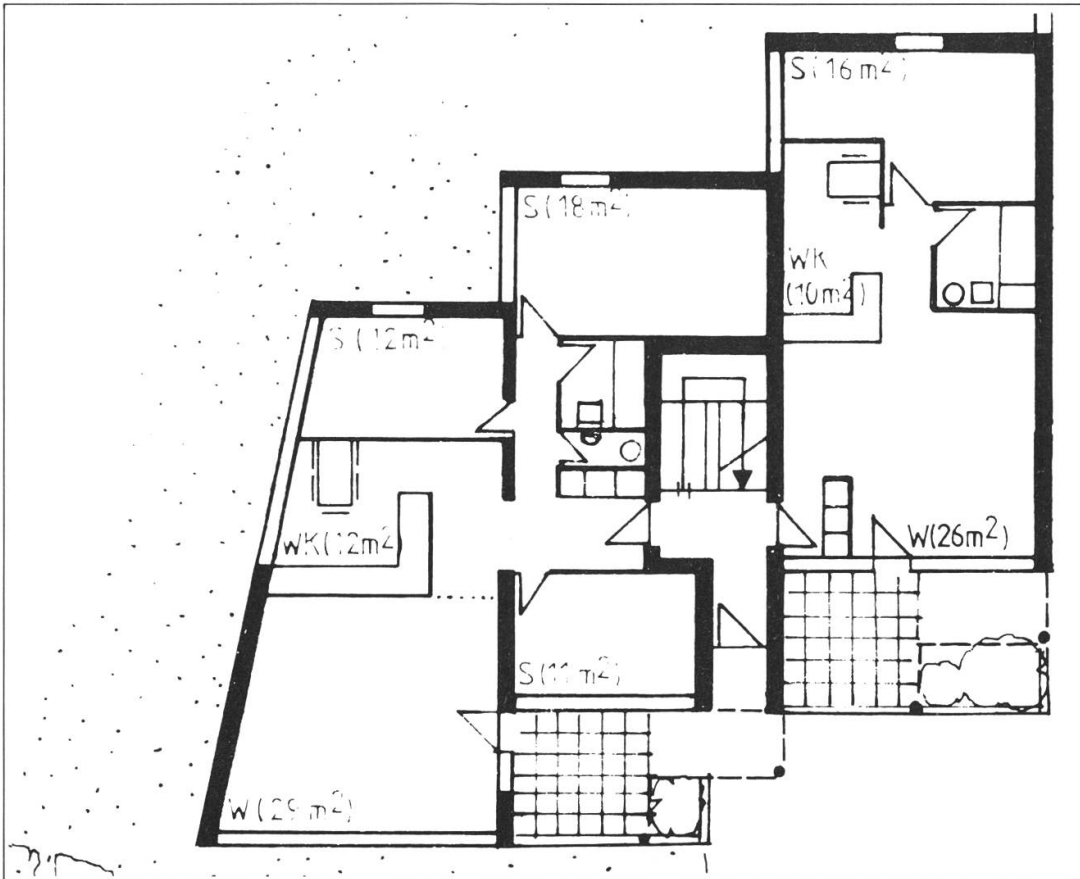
4 1/2- und 2 1/2-Zimmerwohnung laut Vorprojekt mit 105 und 62 m² (Siehe Abb. 2:③)
